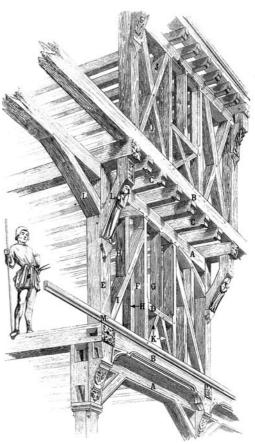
Alzado y sección de una fachada de entramado de madera medieval (Voillet-le-Duc 1864)
